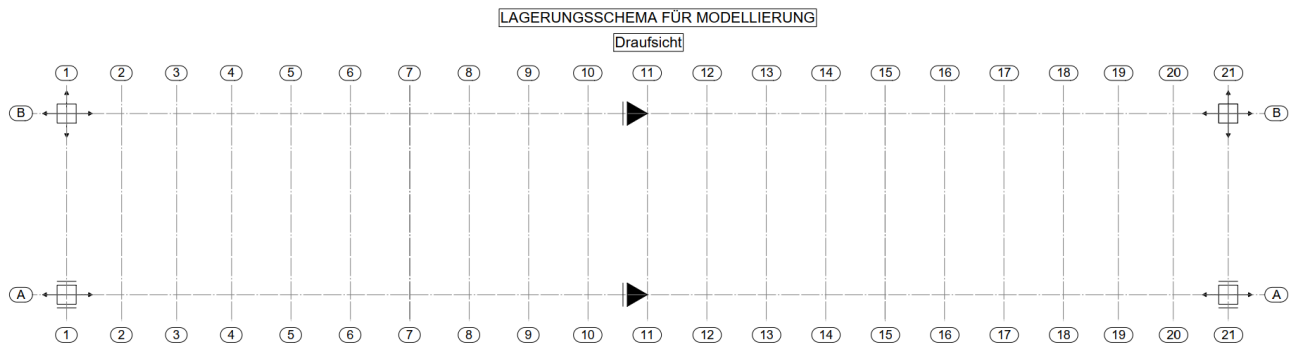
idealisiertes Lagerungsschema für die Modellierung in RFEM – Grundriss
